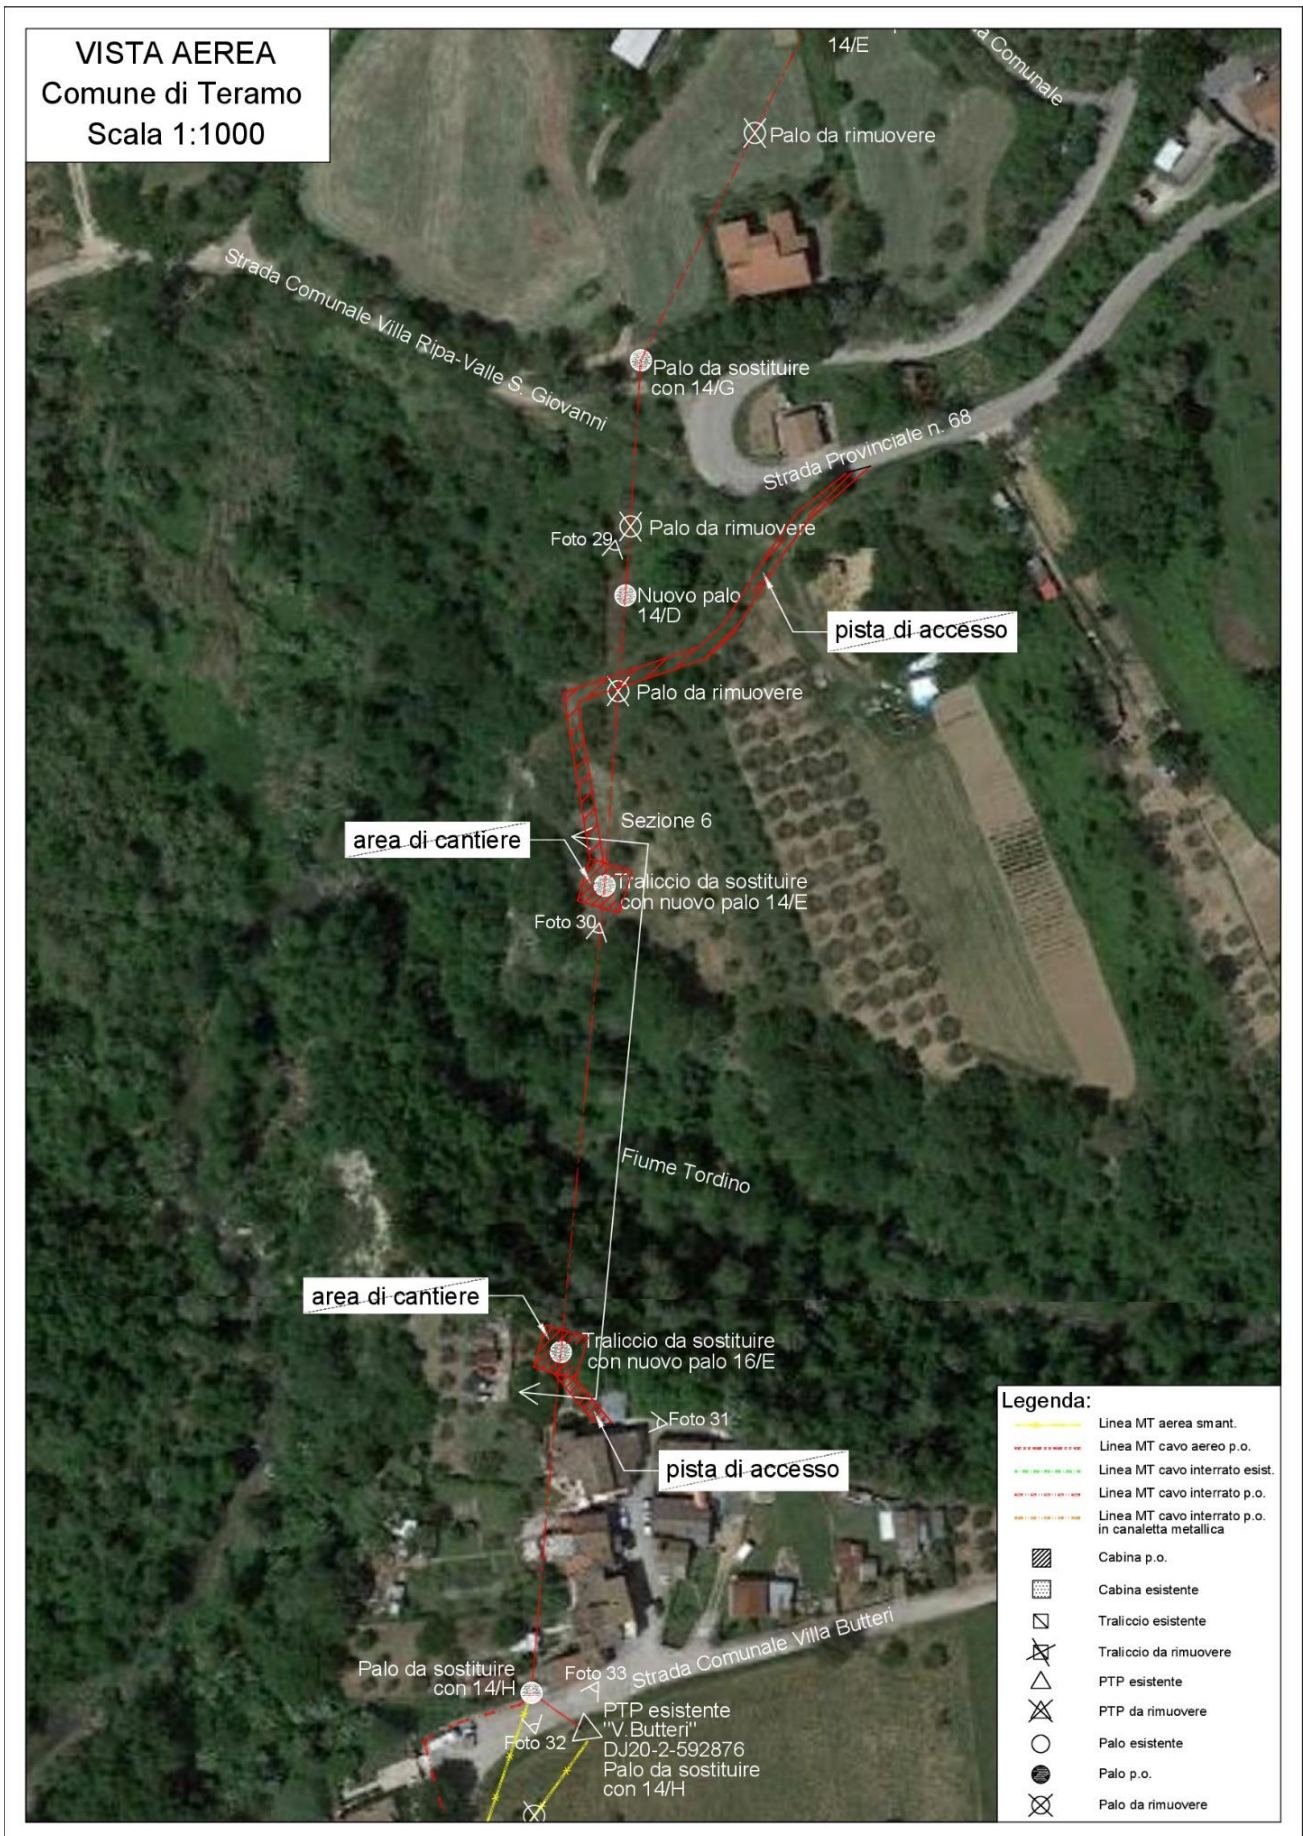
Planimetria di dettaglio con aree di cantiere e piste d'accesso su ortofoto.
